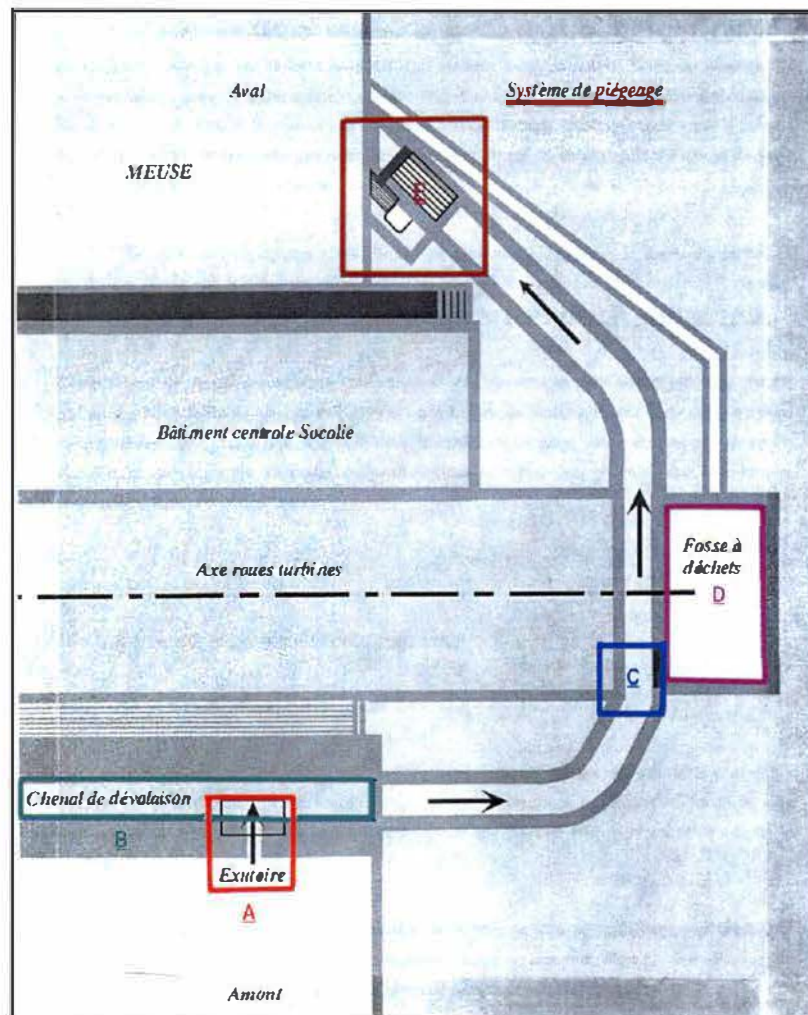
Plan général du système de piégeage à la centrale hydroélectrique de Lixhe
